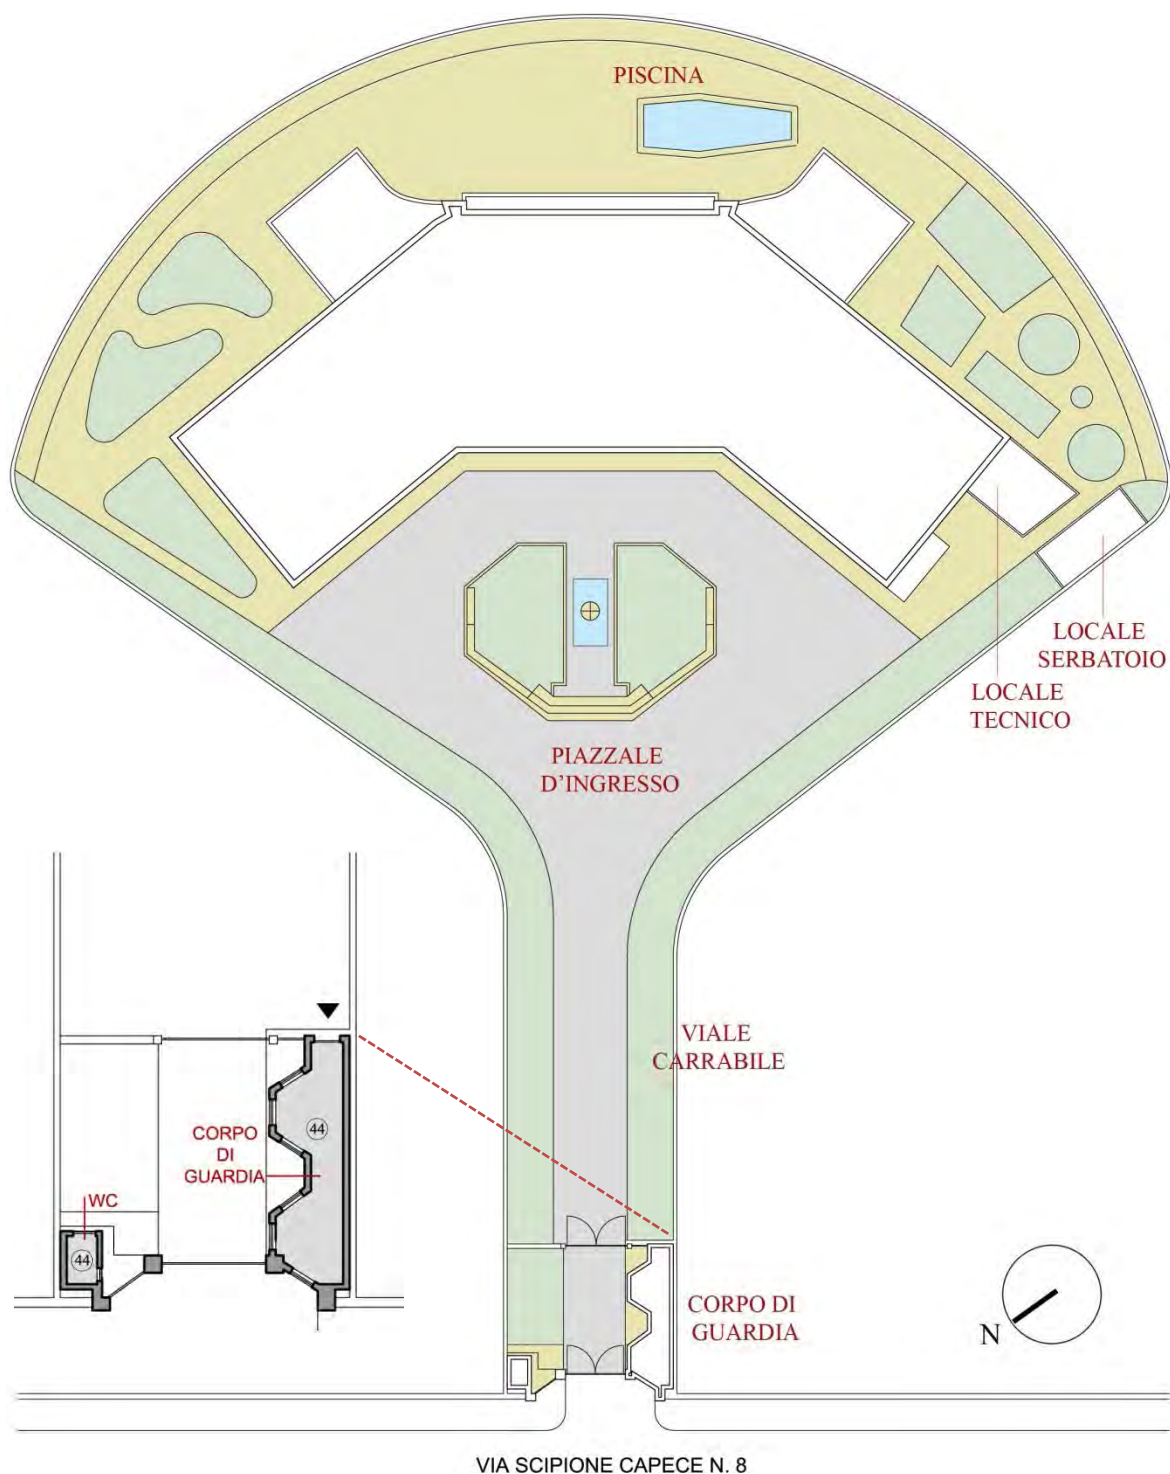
Planimetria generale del lotto e pianta dell'ingresso con il corpo di guardia e il servizio igienico
